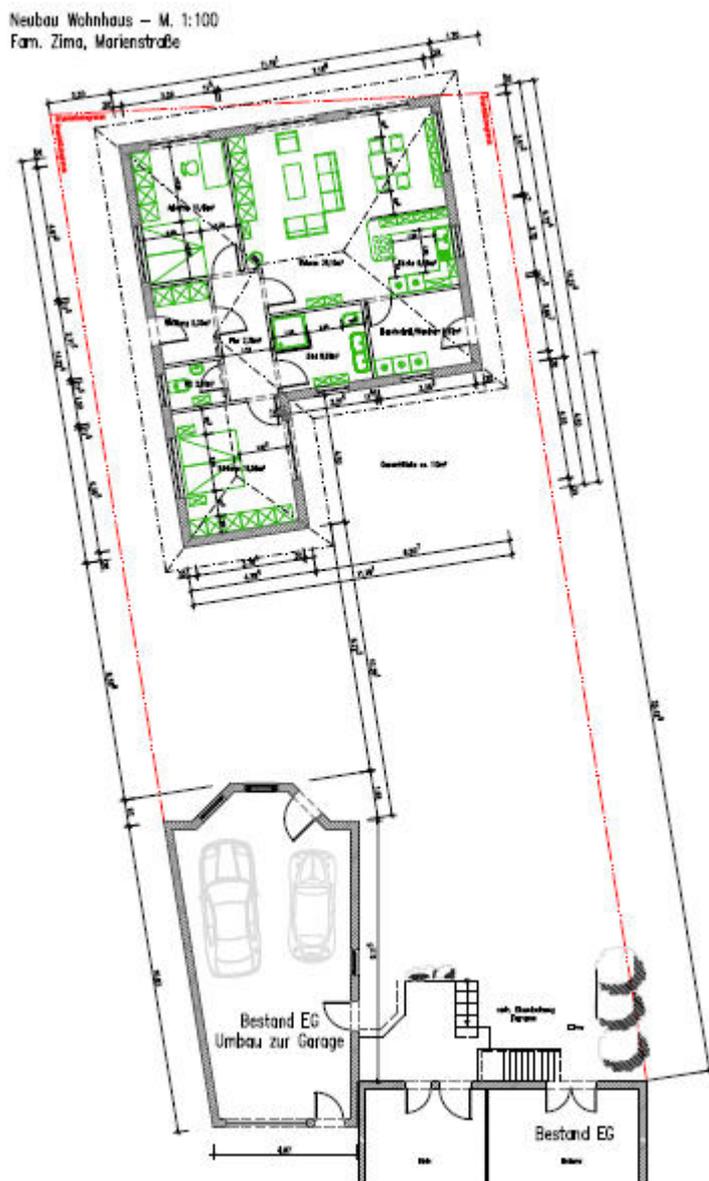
Entwurf einer Darstellung der gewünschten Bebauung
